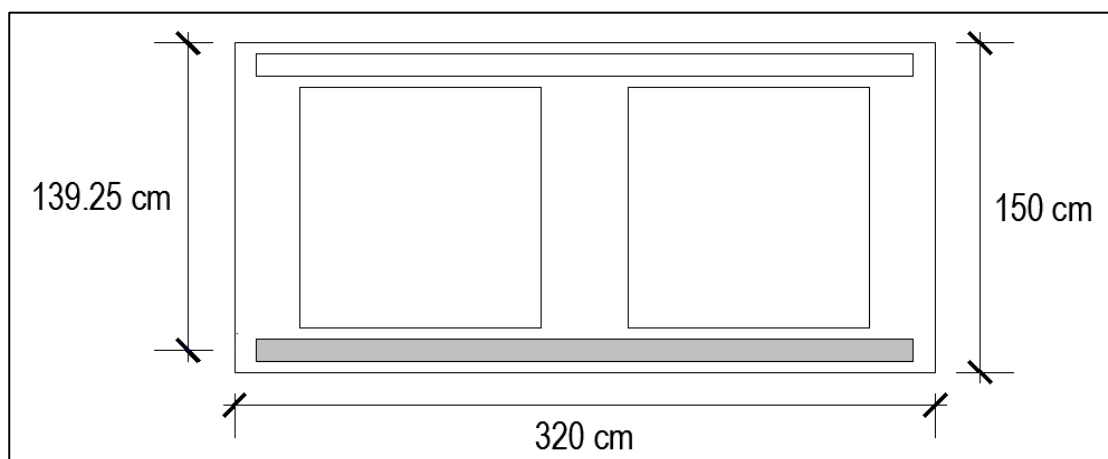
Diseño acero positivo en viga cajón, viga rectangular equivalente.
